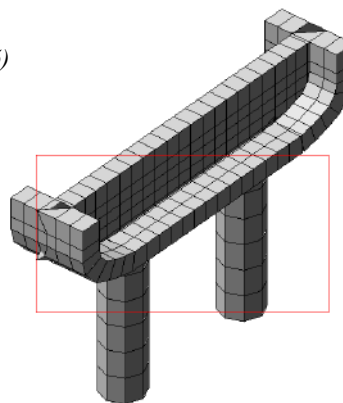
Схема опоры железобетонных конструкций типа ригеля (а);
